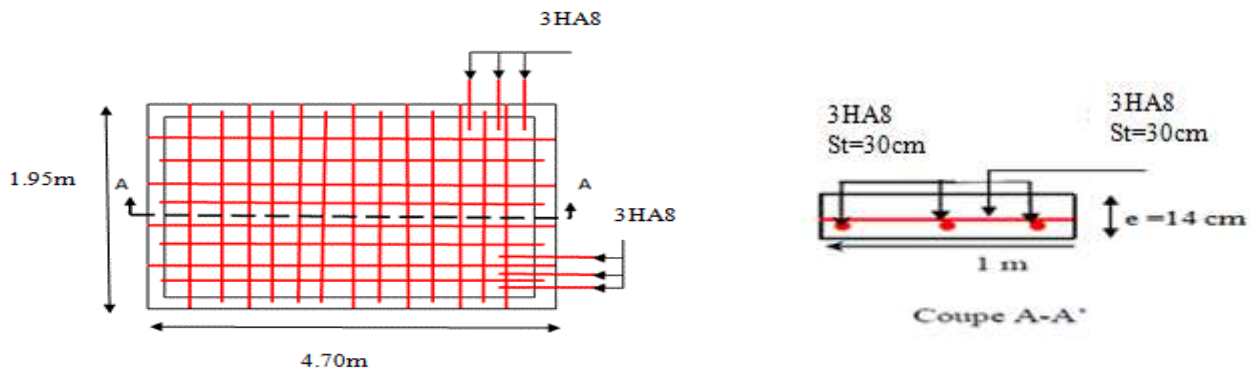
Schéma de ferrailage de la dalle sur quatre appuis D2
